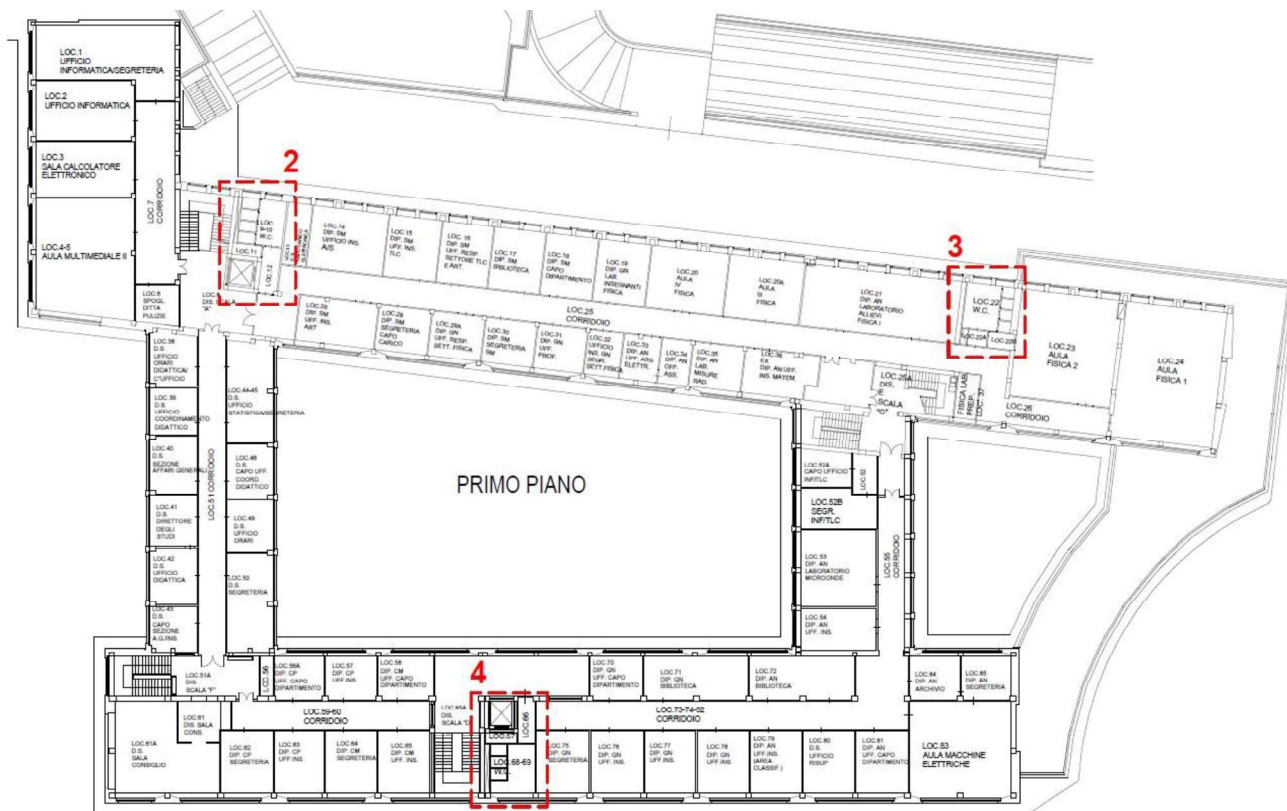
Planimetria primo piano con indicazione dei servizi igienici oggetto di intervento.
